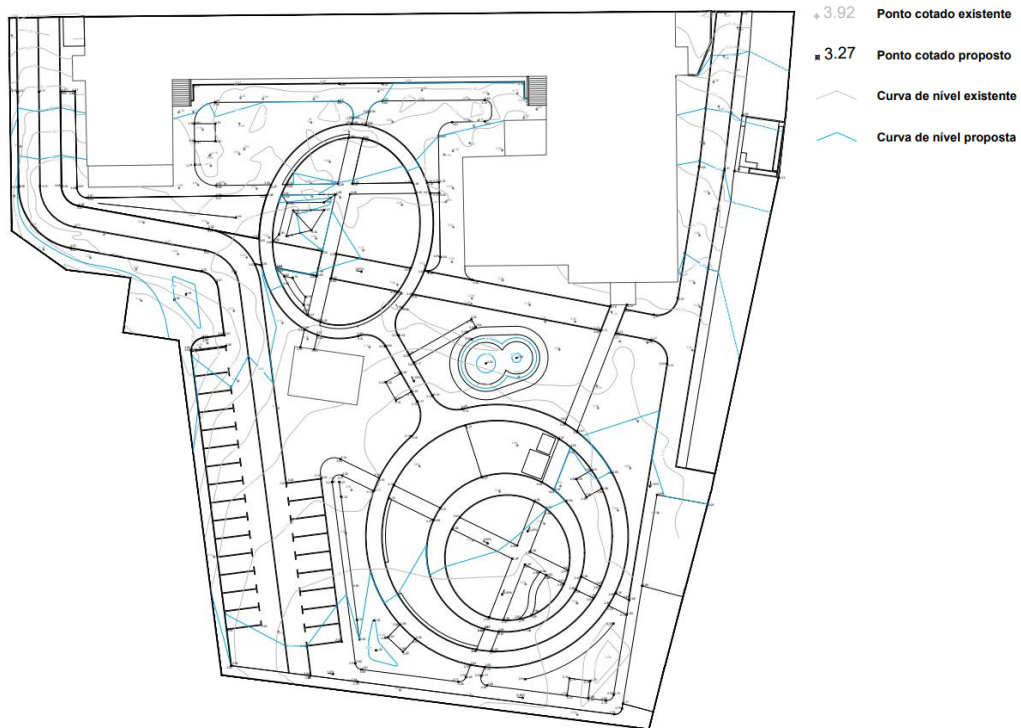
Planta de Altimetria e Modelação do Terreno
